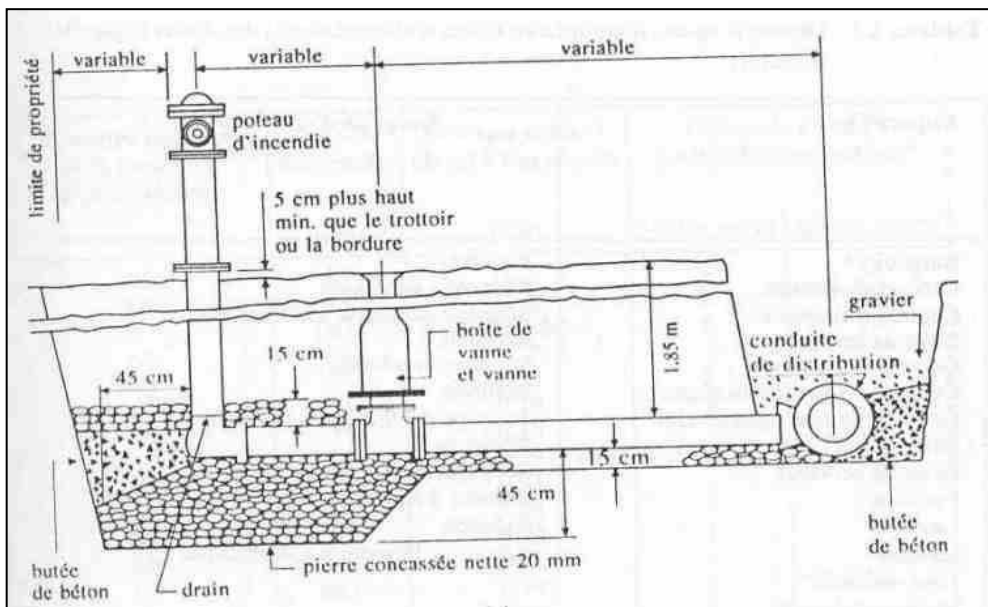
Installation d'un poteau d'incendie vue en coupe
